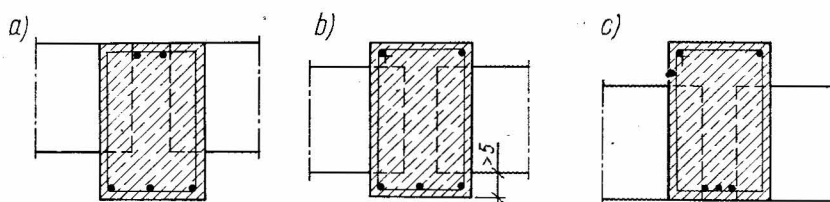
Trois modes de disposition des nervures préfabriquées incorporées dans une poutre-maitresse en béton frais
